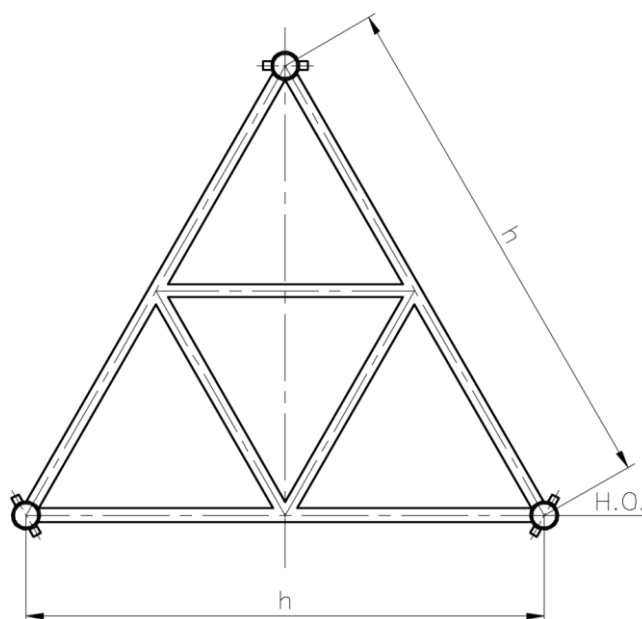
Схема поперечного сечения трехгранной ферменной опорной колоны с цилиндрическими рейками A1
